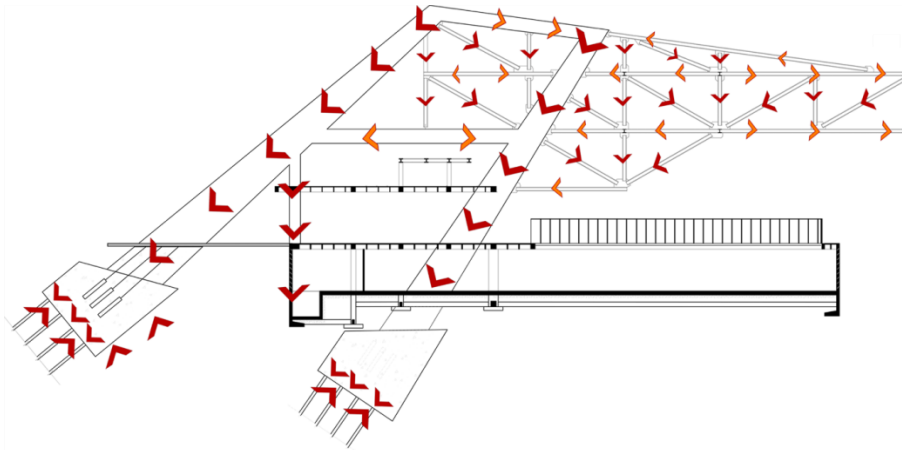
Estructura equipamiento deportivo (Cargas estructurales)
